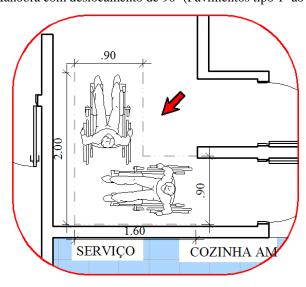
Manobra com deslocamento de 90º (Pavimentos tipo 1º ao 6º) (Detalhe 19)
